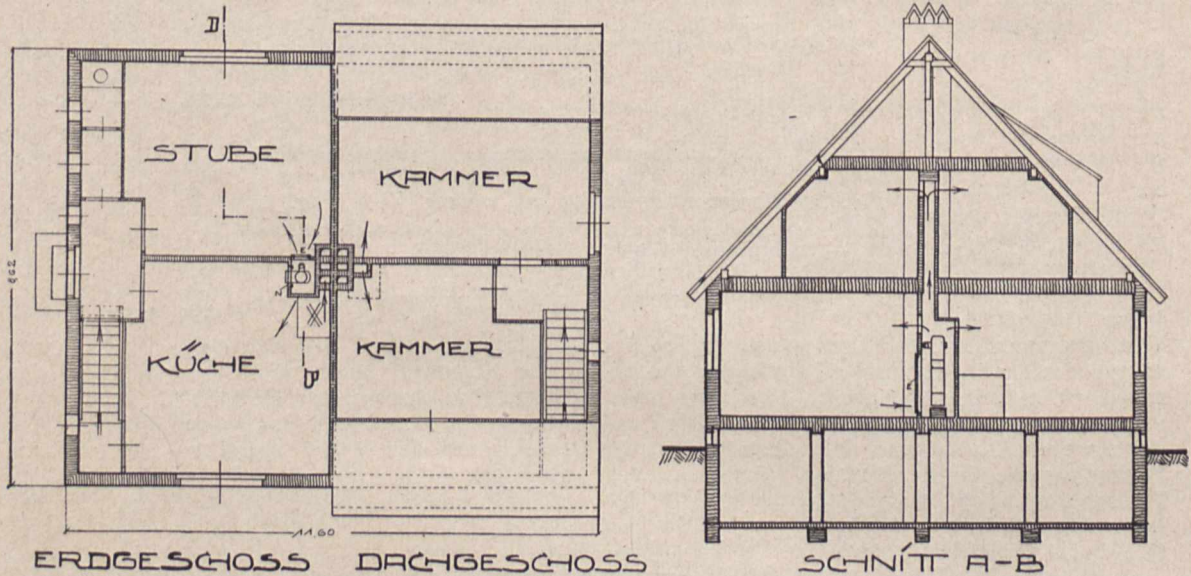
Zweifamilienhaus (Doppelhaus) mit eingebauter Umluftheizung. Grundrisse und Querschnitt im Maßstab 1 : 150.
